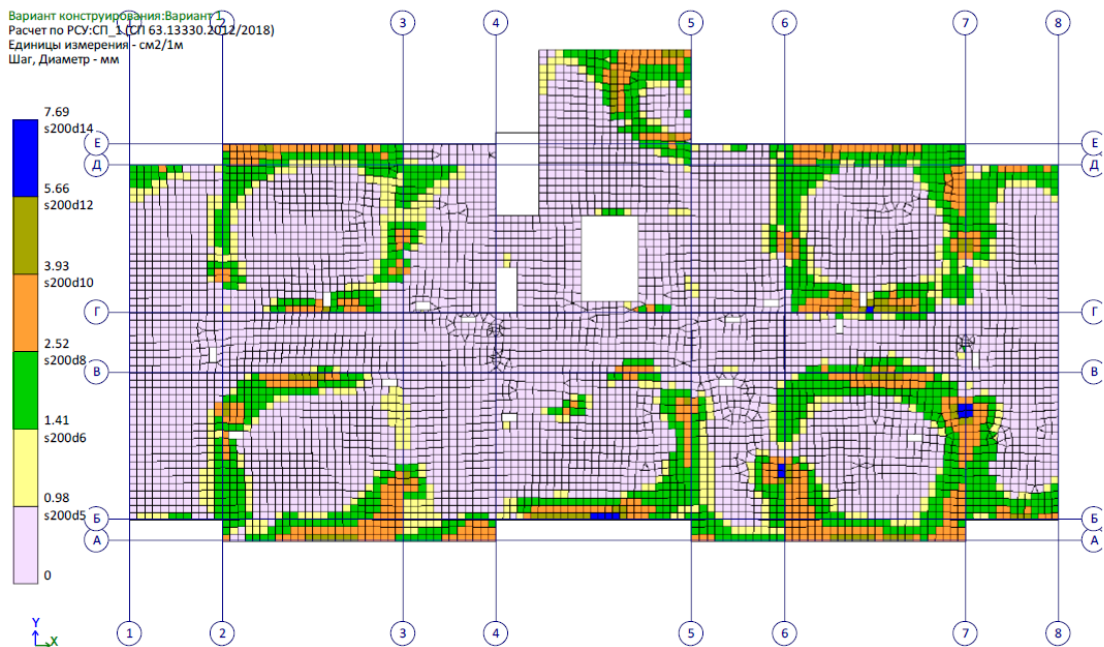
Площадь полной арматуры на 1пм по оси Y у верхней грани ПЛИТЫ
